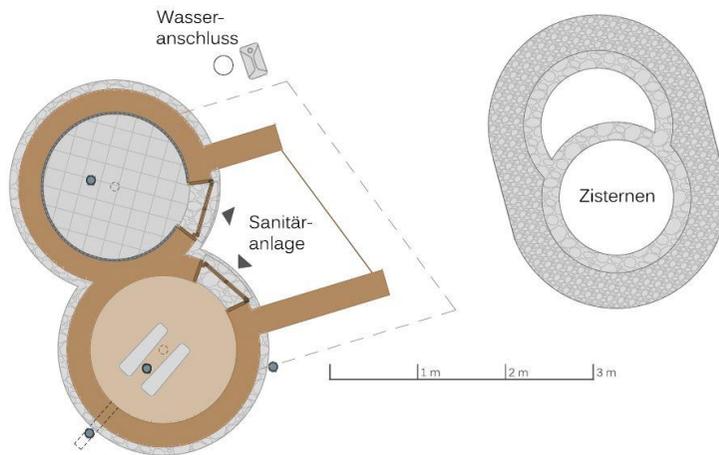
Grundriss Sanitäranlage
